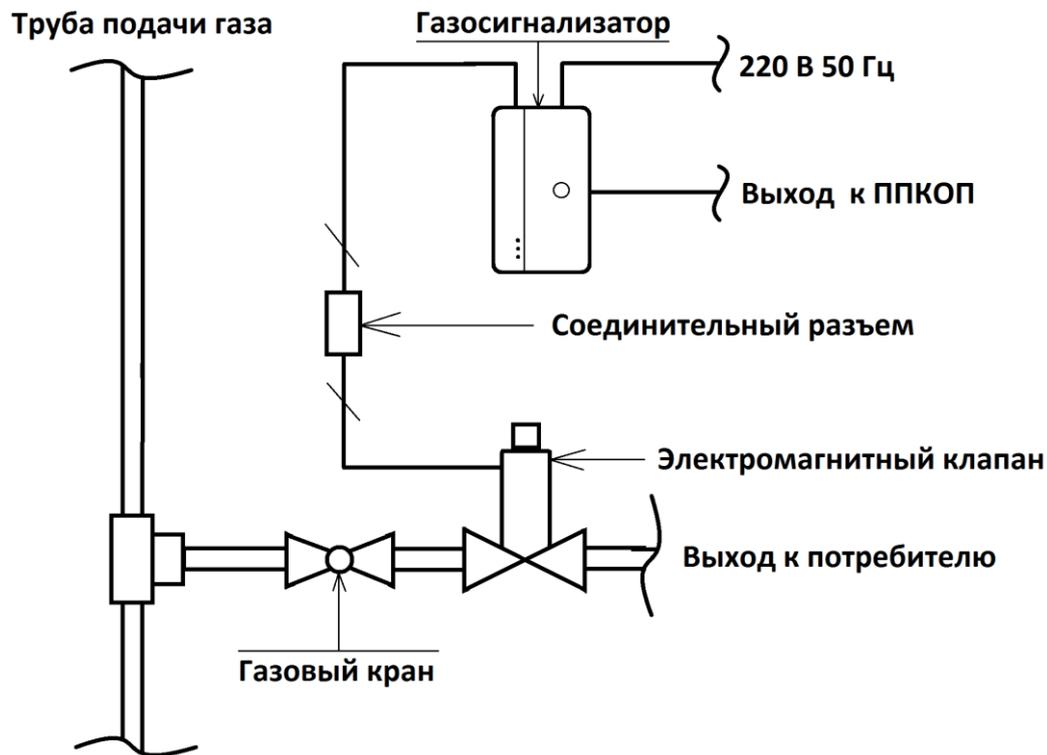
Схема соединения сигнализатора с внешними исполнительными устройствами
